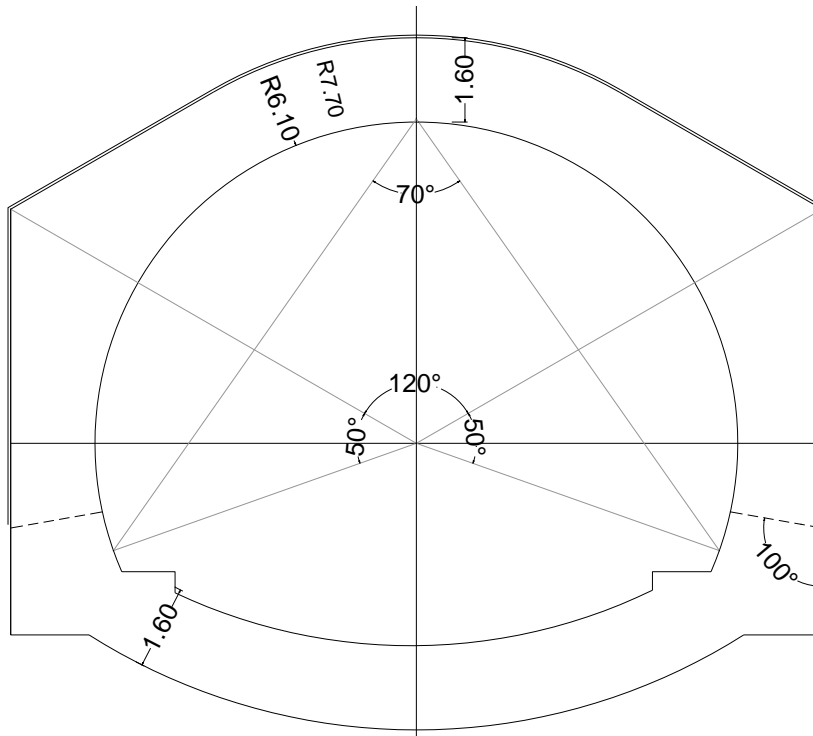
Sezione trasversale galleria artificiale_Tipo 2.
